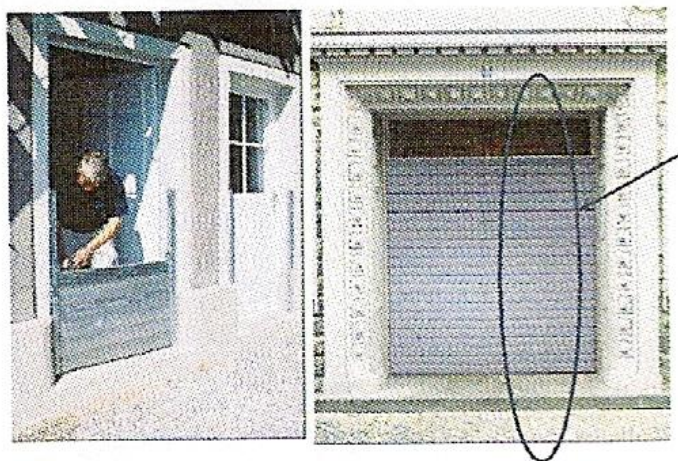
อุปกรณ์ป้องกันน้ำ Flood Barriers
